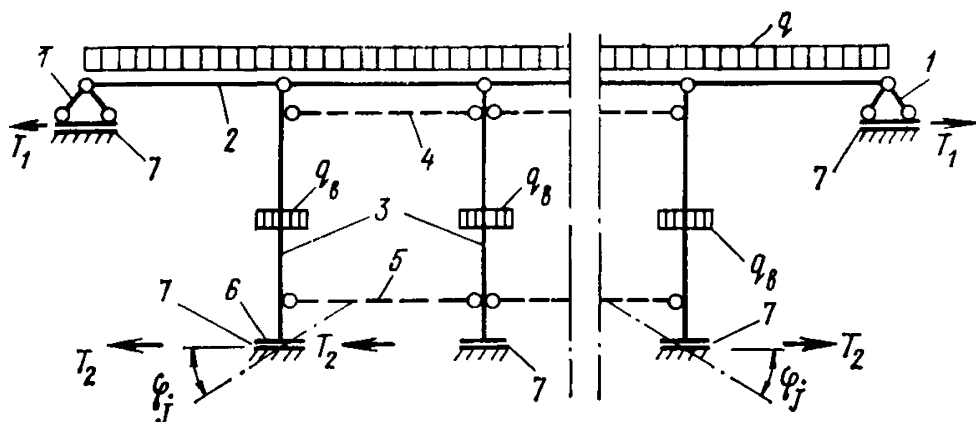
Расчетная и нагрузочная схема системы железобетонных и металлических элементов грунтового резервуара в продольном и поперечном направлениях
